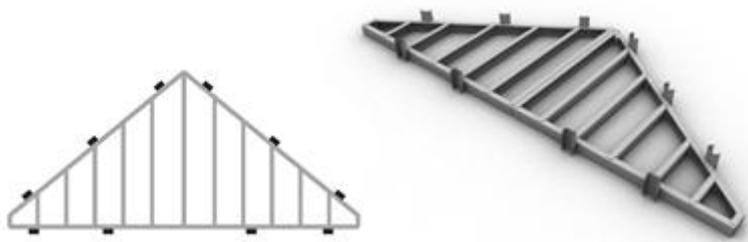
Сборка шаблона для внутренних стропильных ферм
